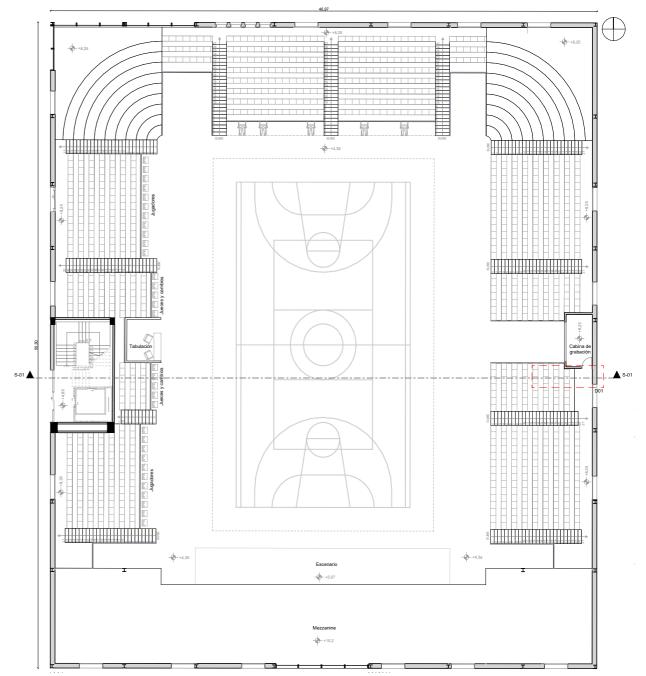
Bloque 1 - planta +11,2 ESC_1:325 Elaborado por: Autor
